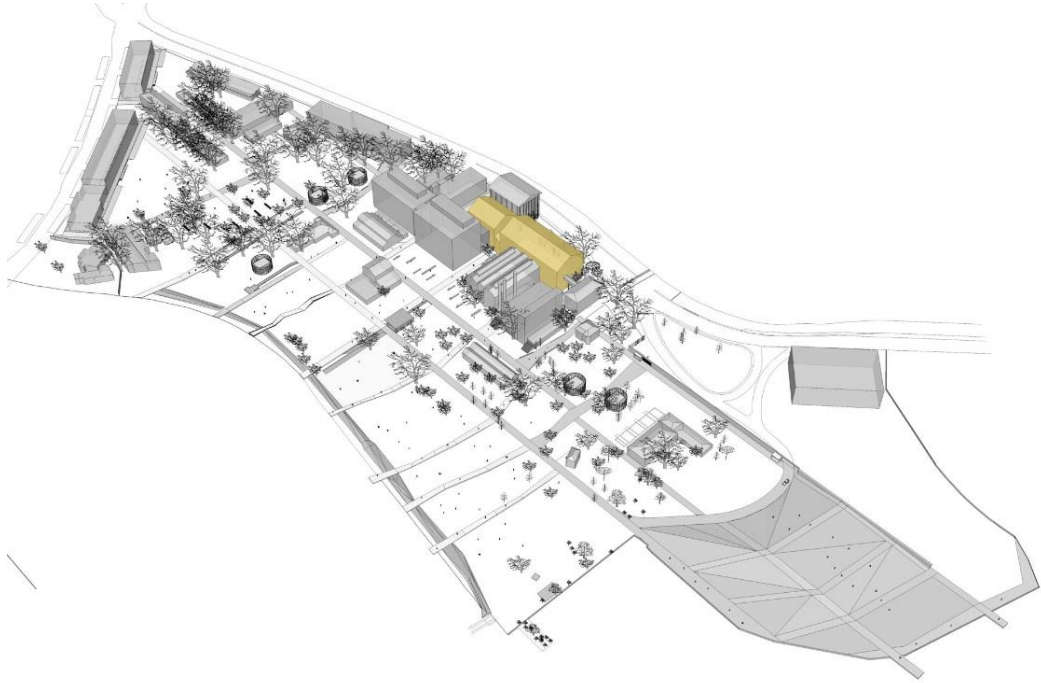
Seka Kağıt Müzesi ve Bilim Merkezi Vaziyet Planı
